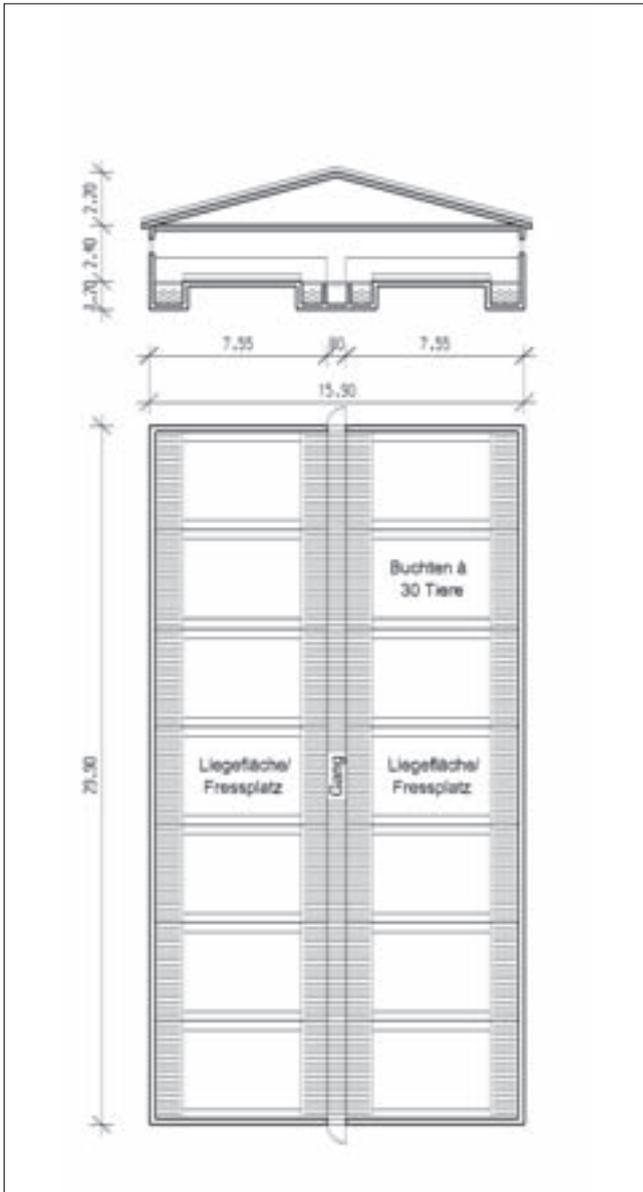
QM-Maststall für 420 Mastschweine. Geschlossener, wärmegeprägter Stall mit Rein/Raus, Buchten für 30 Tiere. Entmistung mit Schwemmkanal und Umspülung.
